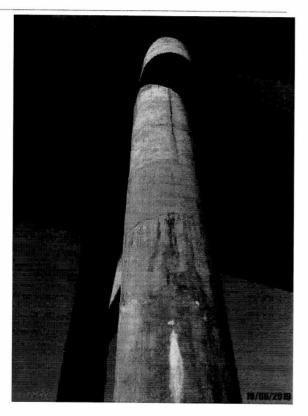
Detalhe de pilares com pequenas fissuras e pontos de desplacamento de concreto.
